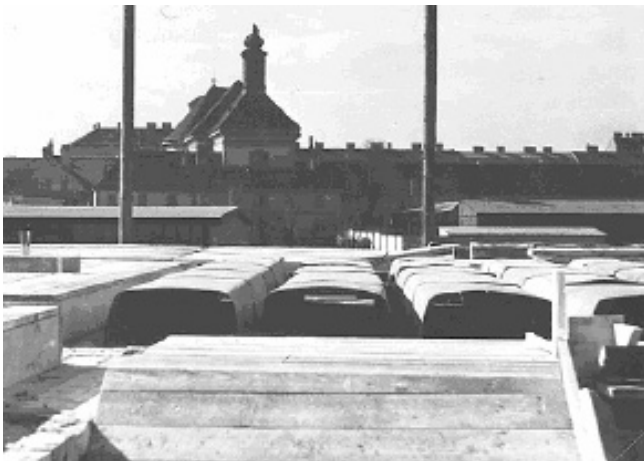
Schalungselemente für Stahlbeton-Rippendecken
